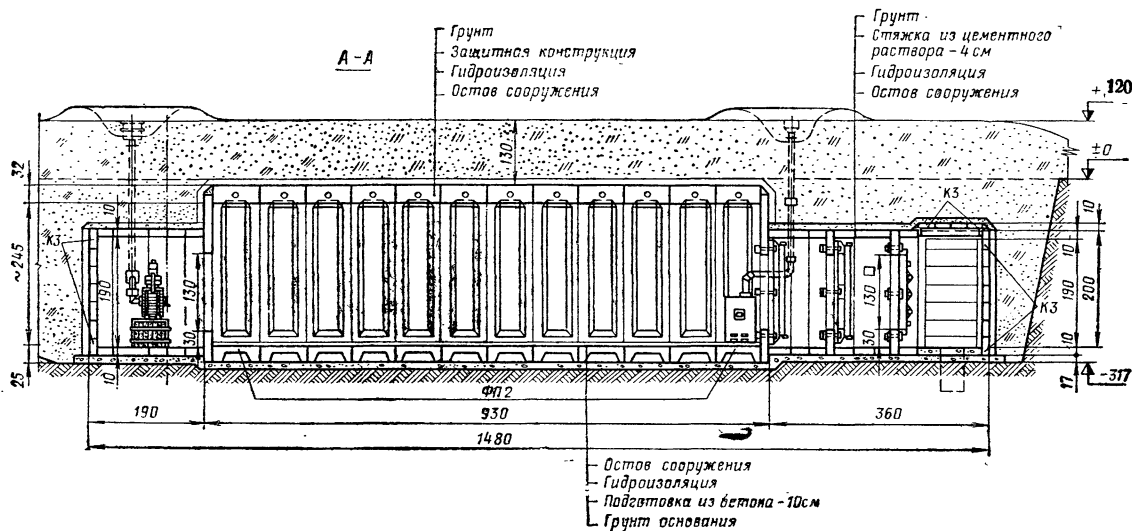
Сборное железобетонное сооружение СБК (разрезы)
